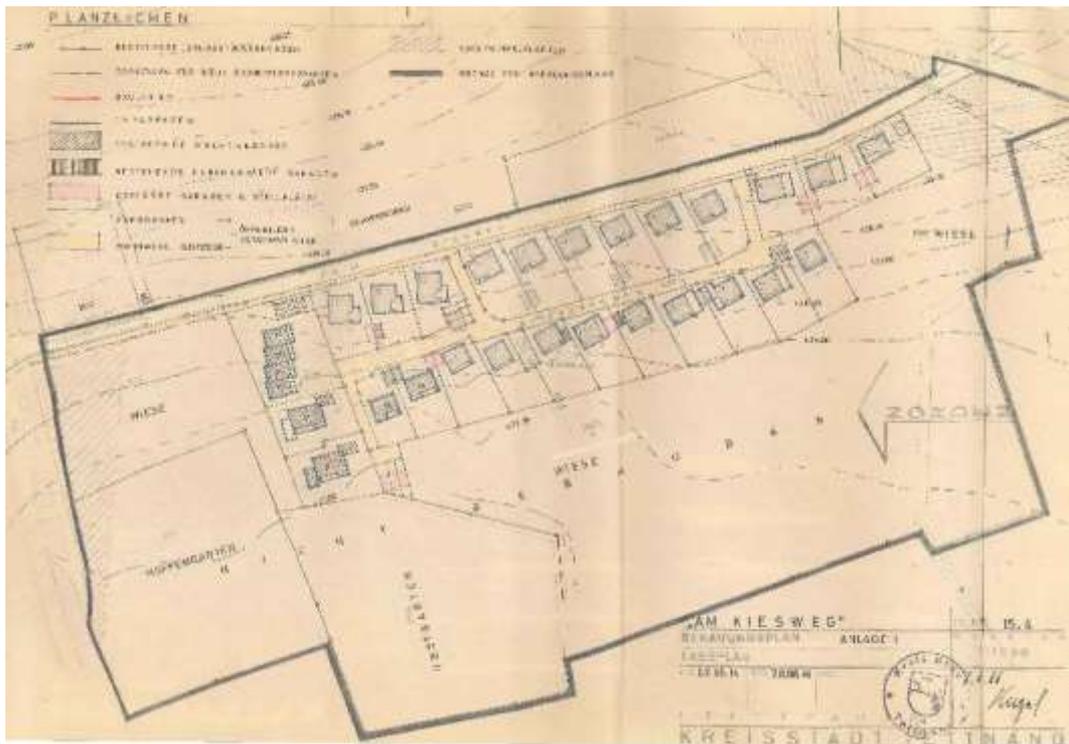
Bebauungsplan „Am Kiesweg“, 1966, o.M. (Quelle: Homepage Stadt Tettngang)
